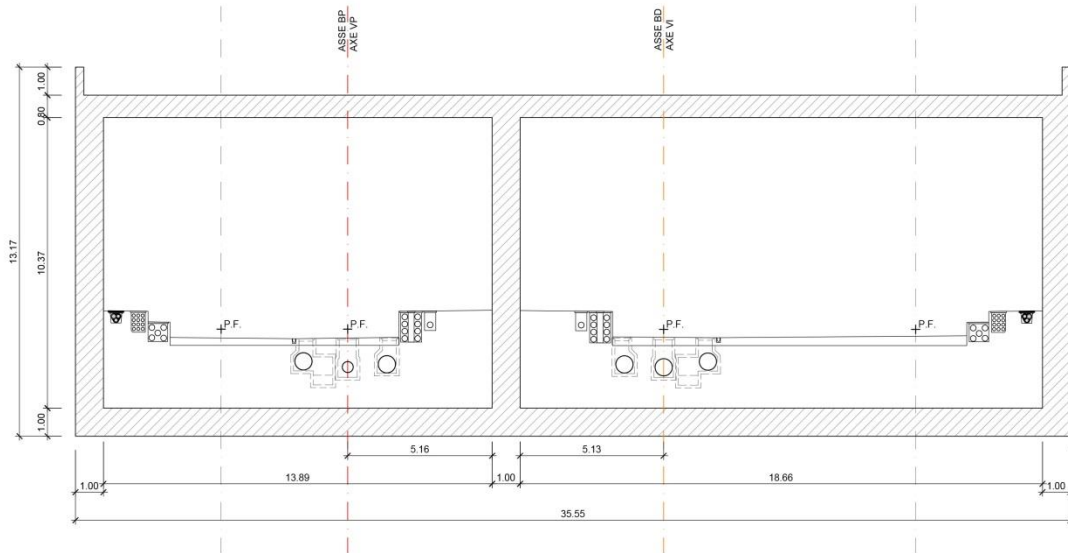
Sezione tipo galleria artificiale BP pk 61+084– 61+116.52
